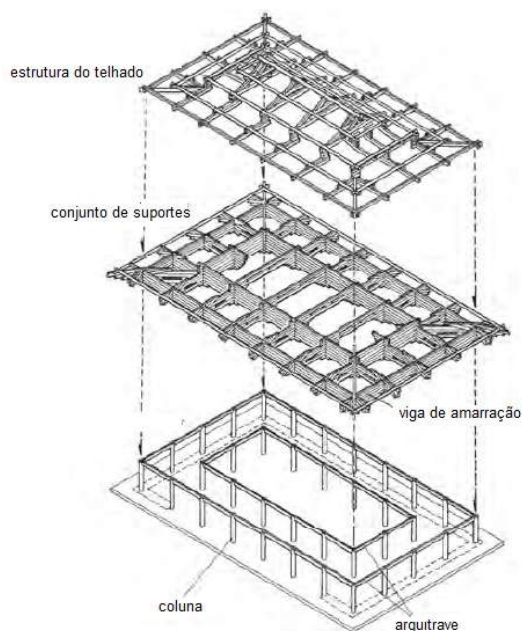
Esquema que facilita a visualização das camadas da estrutura.
